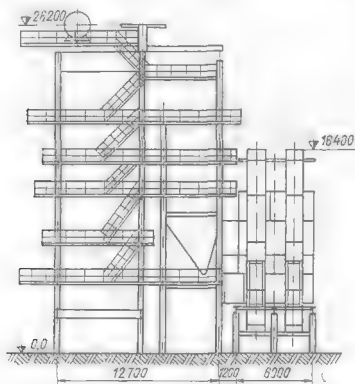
Схема компоновки ДРВ с котлом БКЗ-320-140ГМ
